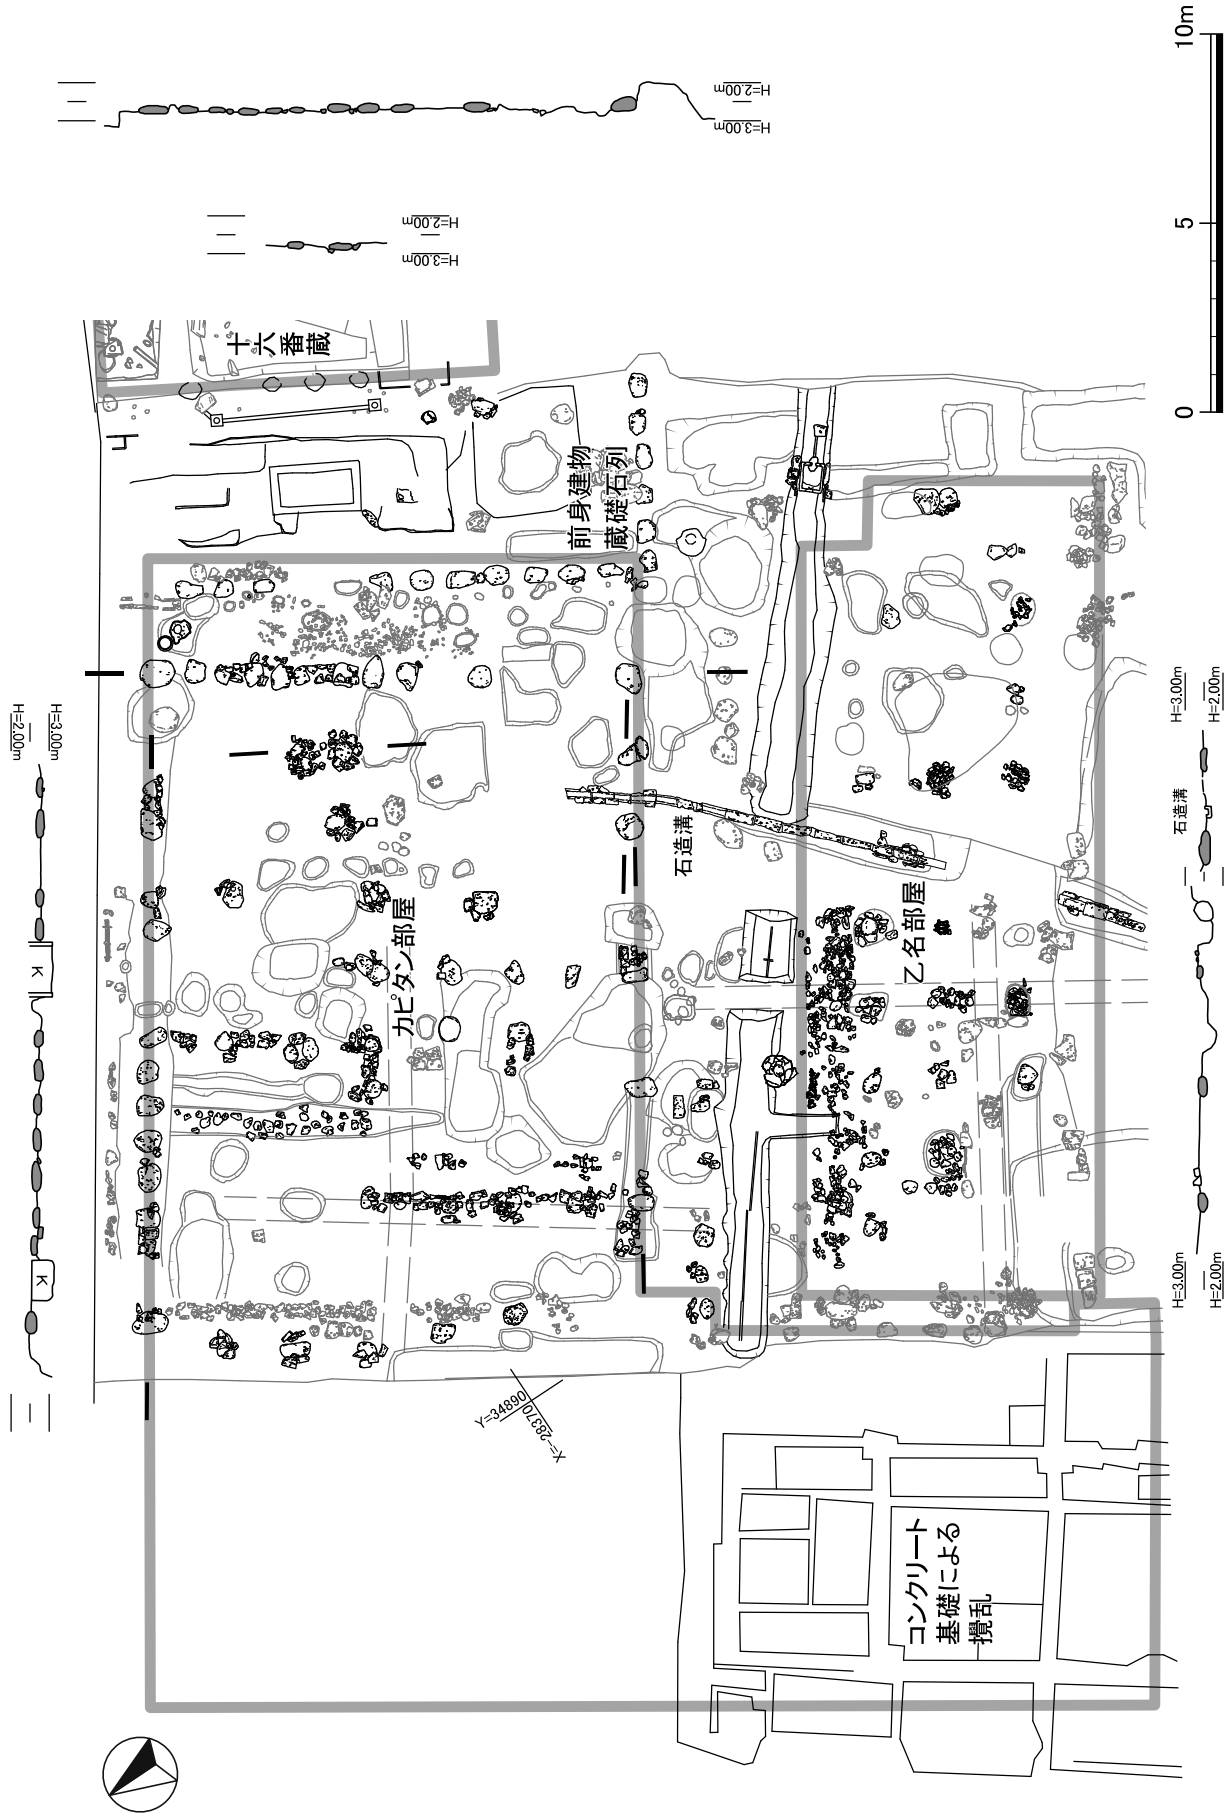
カピタン部屋 平面図・断面図 (S=1/200)
